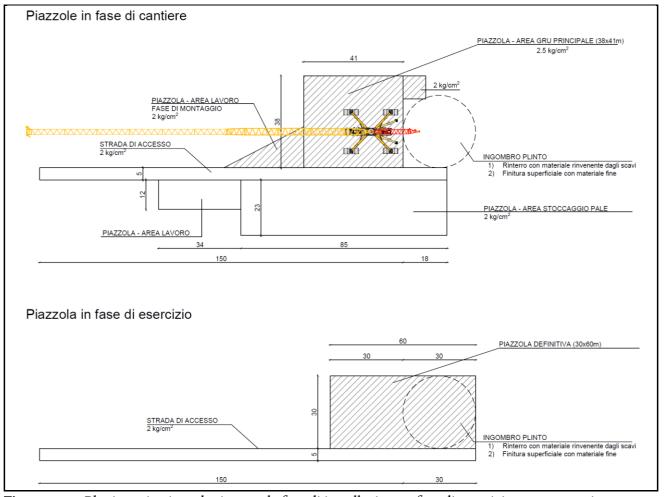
Planimetria piazzola tipo per la fase di installazione e fase di esercizio e manutenzione
